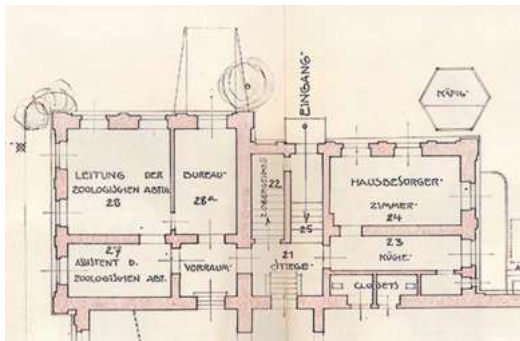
Rekonstruktionsgrundlagen Nordpavillon und Anbau:
